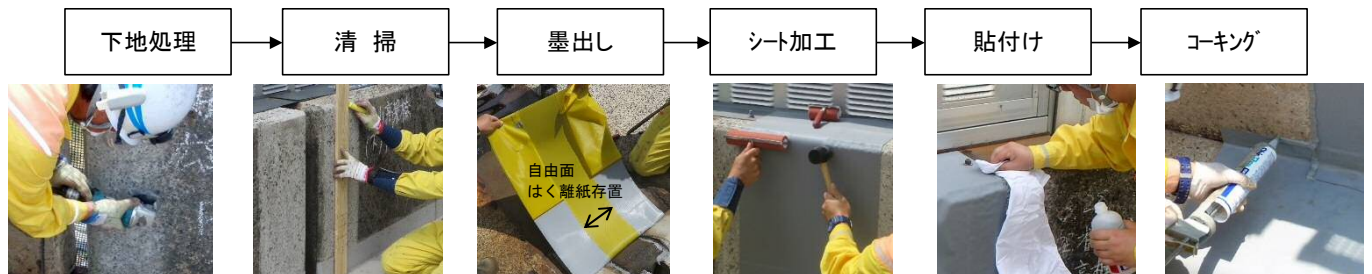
下地処理 写真-5 墨出し 写真-6 シート貼付 写真-7 押さえ 写真-8 アルコール清掃 写真-9 コーキング
